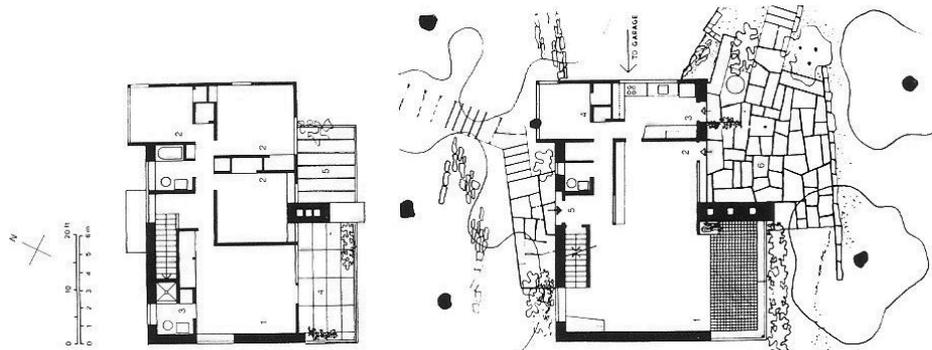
| Planta baixa e segundo pavimento da Casa J. Oser [McCARTER]
